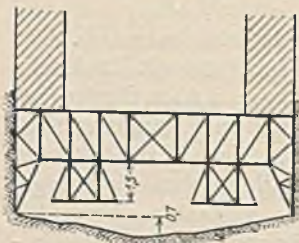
Abfangvorrichtung in weichen Bodenschichten.
